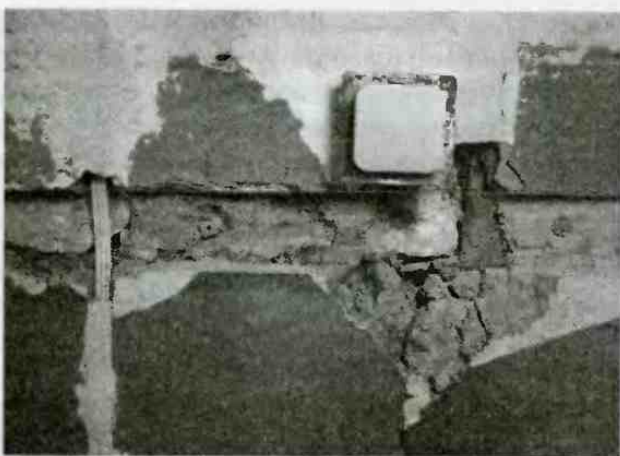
Прокладка или замена электропроводки связаны со штроблением стен, поэтому этот вид работ делают одним из первых
